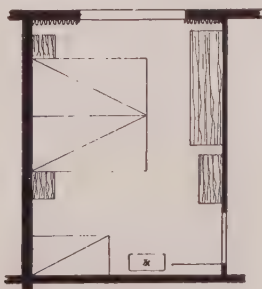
Möblierung mit handelsüblichen Möbeln (2,30 m<sup>2</sup> Schrankraum)
